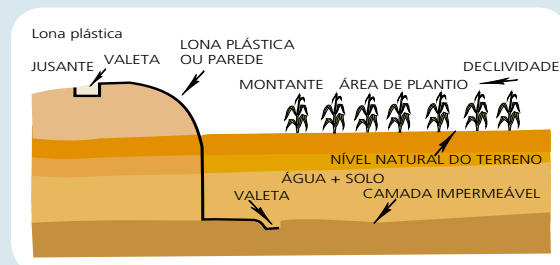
Barragem subterrânea ou submersível (Brito et al., 1999)
